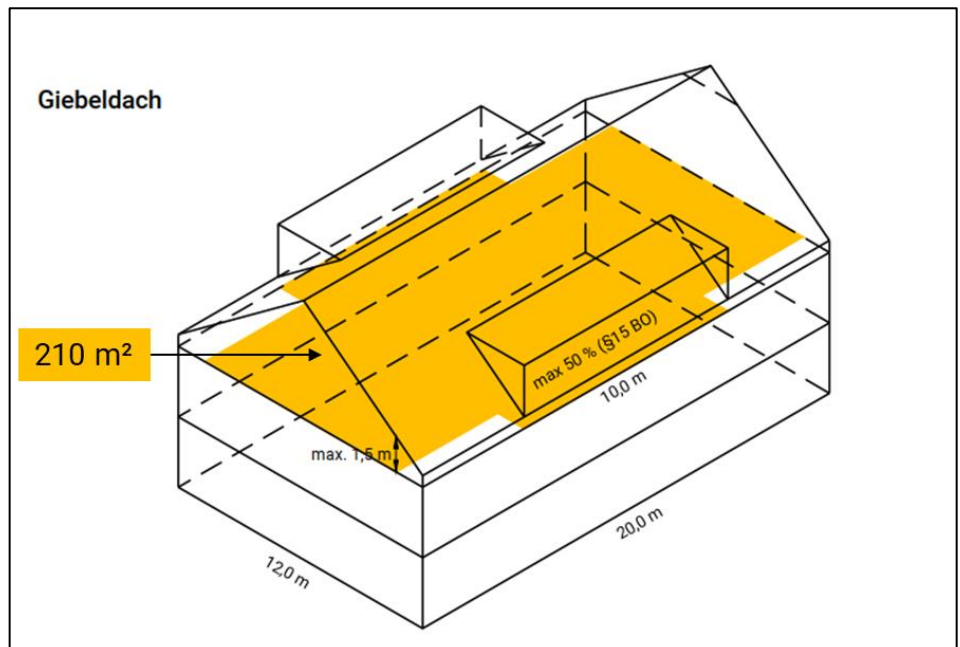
Erläuterungsskizze Messweise «Neu», Dachgeschoss zum Grossteil anzurechnen, R+K
